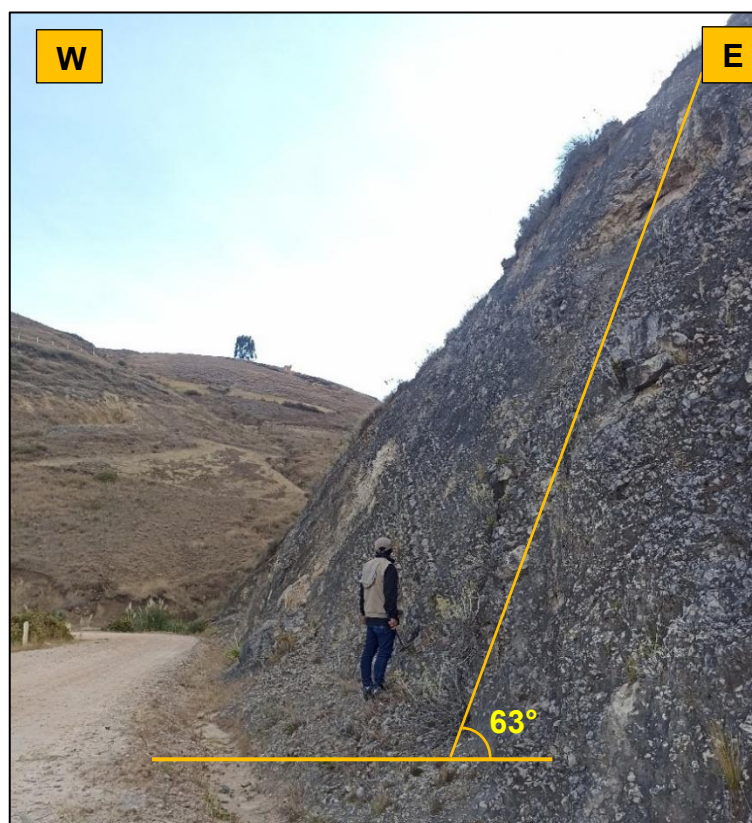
Perfil del talud en la progresiva Km 7 + 300
